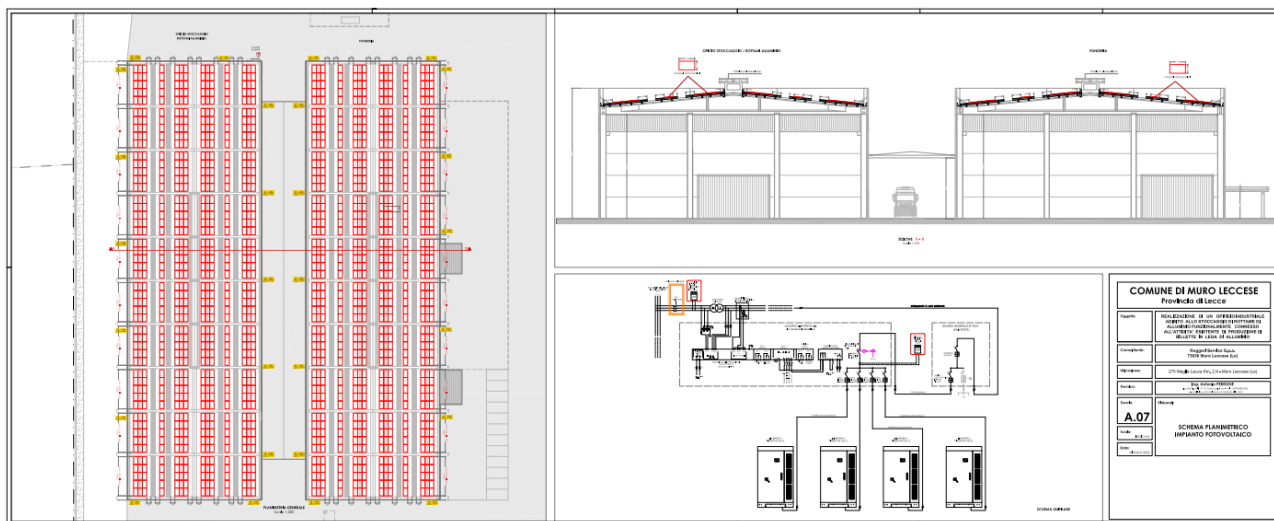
Schema planimetrico impianto fotovoltaico.
